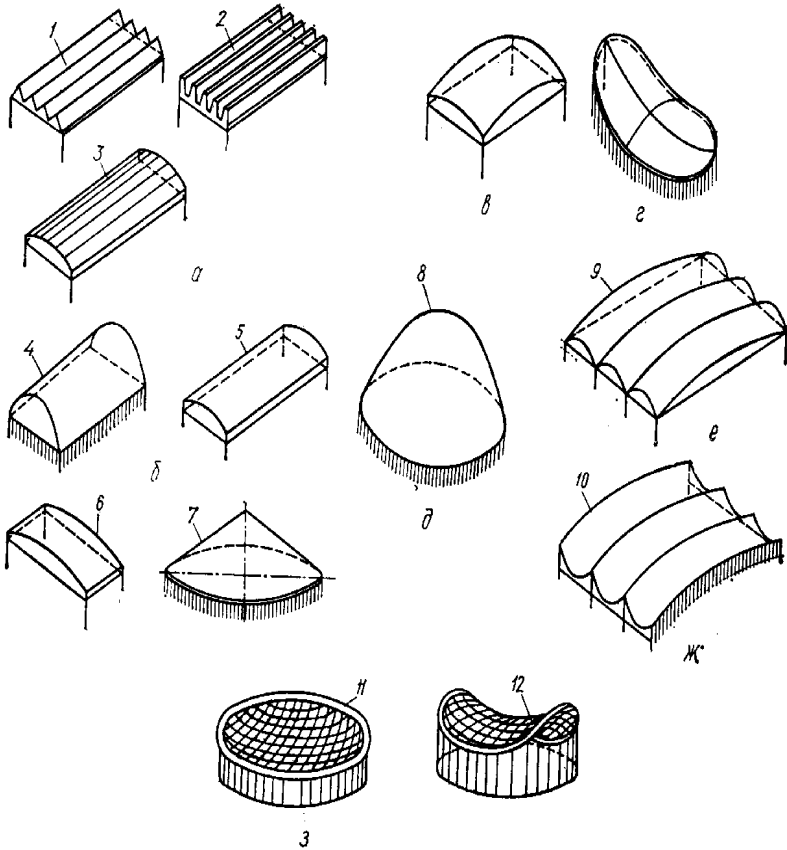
Схеми тонкостінних просторових конструкцій покриттів:
